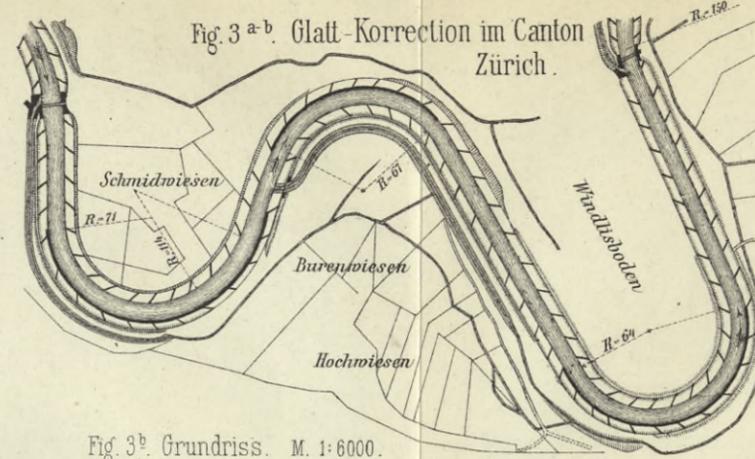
^b. Grundriss. M. 1:6000.
